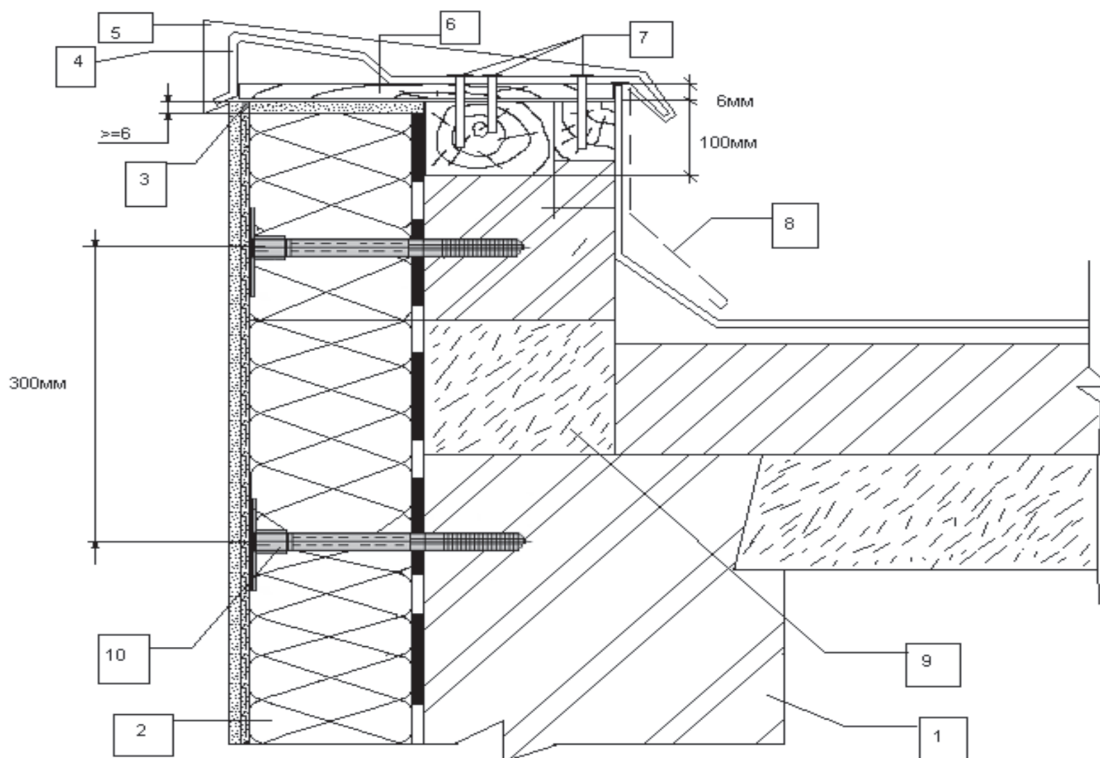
Устройство теплоизоляции на последнем этаже в здании с плоской крышей:
